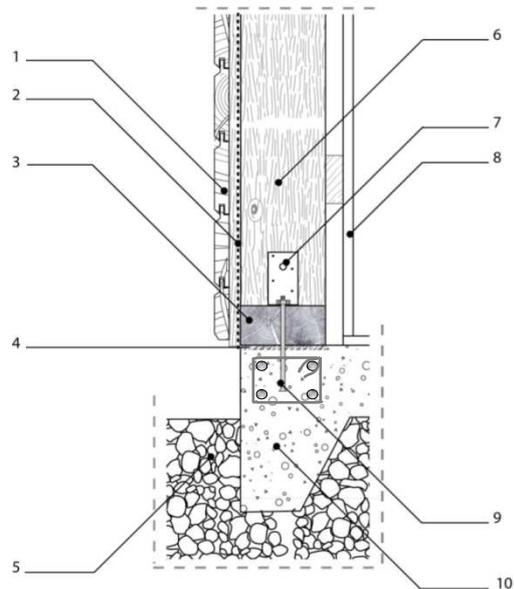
Coupe verticale de principe : Détail d'ancrage d'une lisse basse d'un mur extérieur sur radier - panneau courant secondaire de mur de façade.
